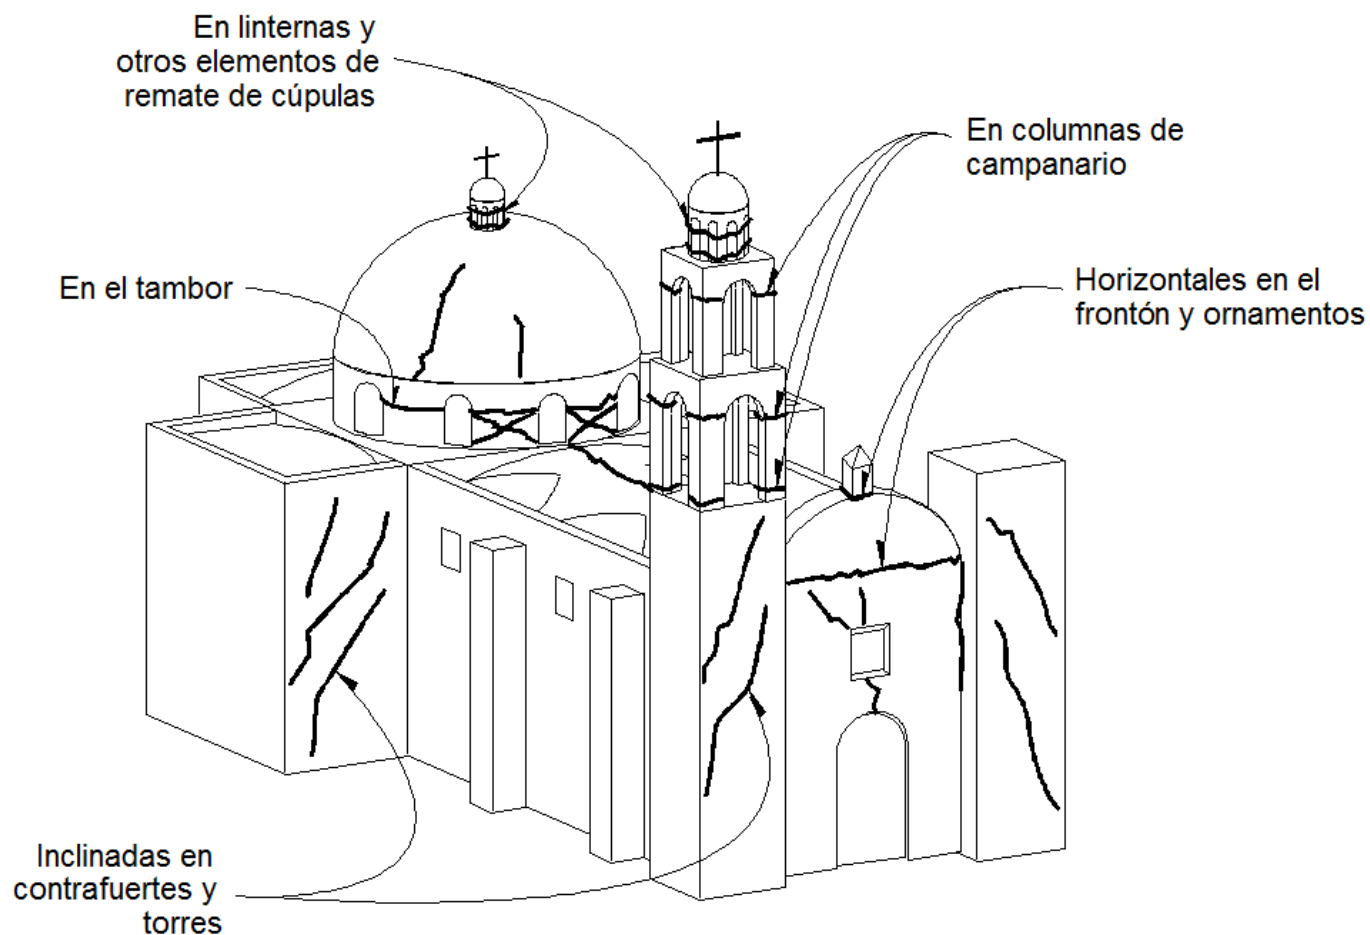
CENAPRED, Ingeniería estructural y Geotecnia (1999). Pag 91
